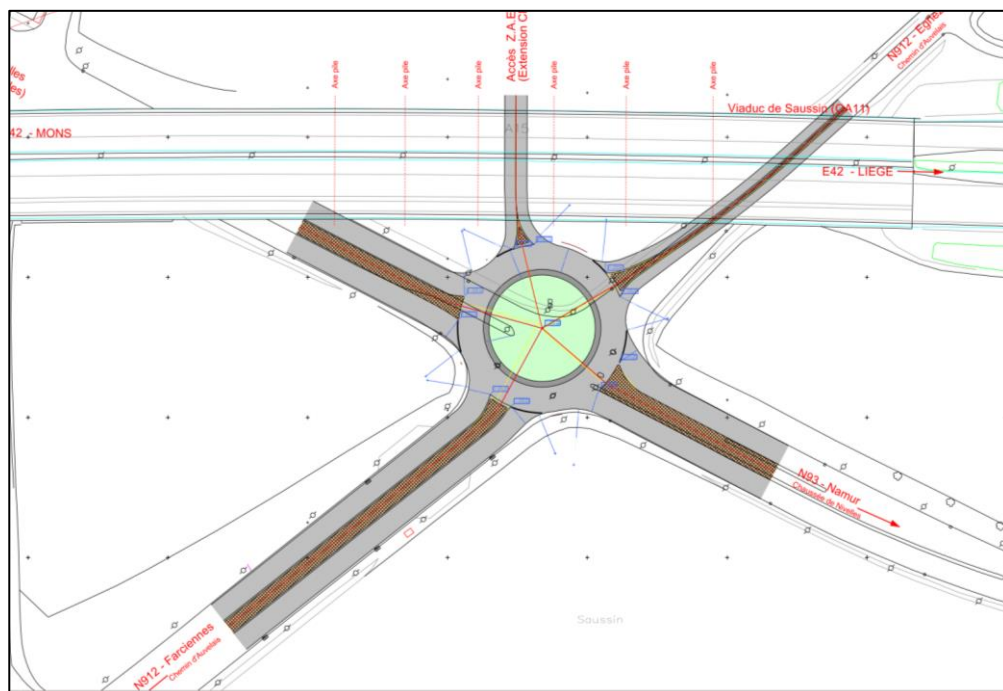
plan de nouveau rond-point prévu au carrefour N93-N912 (source SPW)
